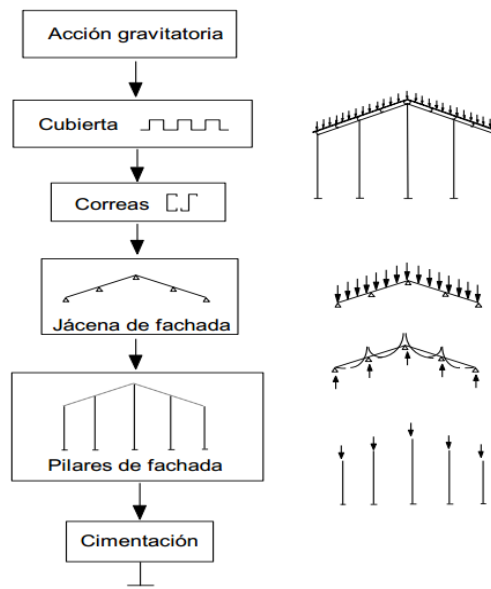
Esquema de transmisión de cargas contenidas en plano de pórtico. [3. Construcción T1, 14/15].
